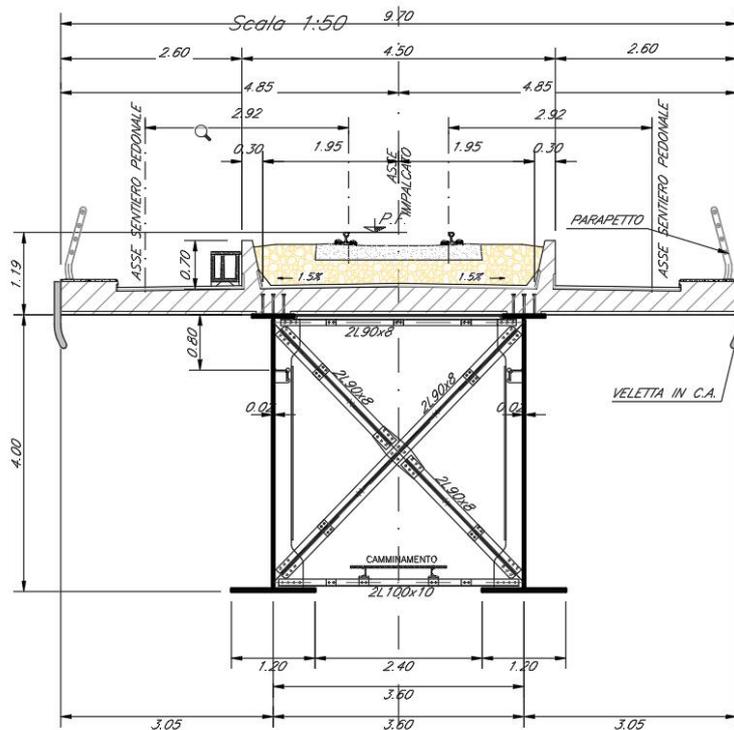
sezione trasversale impalcato tipo in acciaio 50m singolo binario
